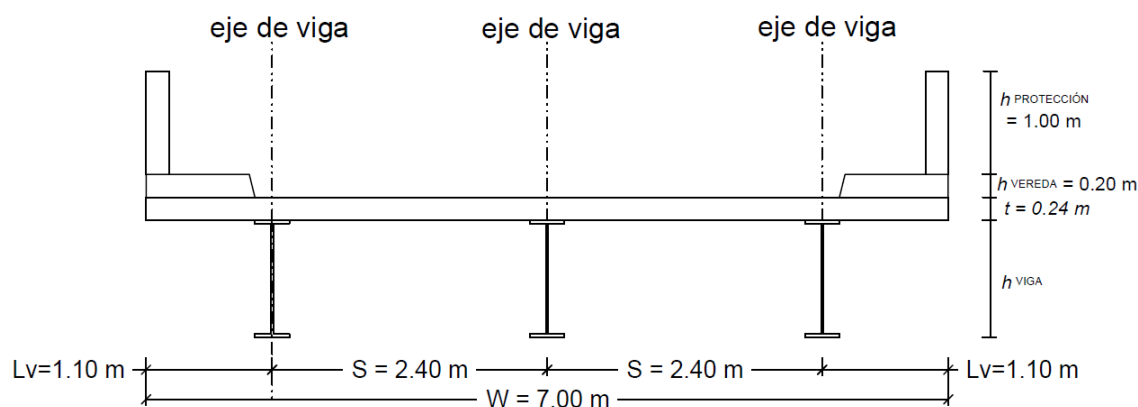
Sección transversal de la superestructura del puente. Elaborado por: El autor
